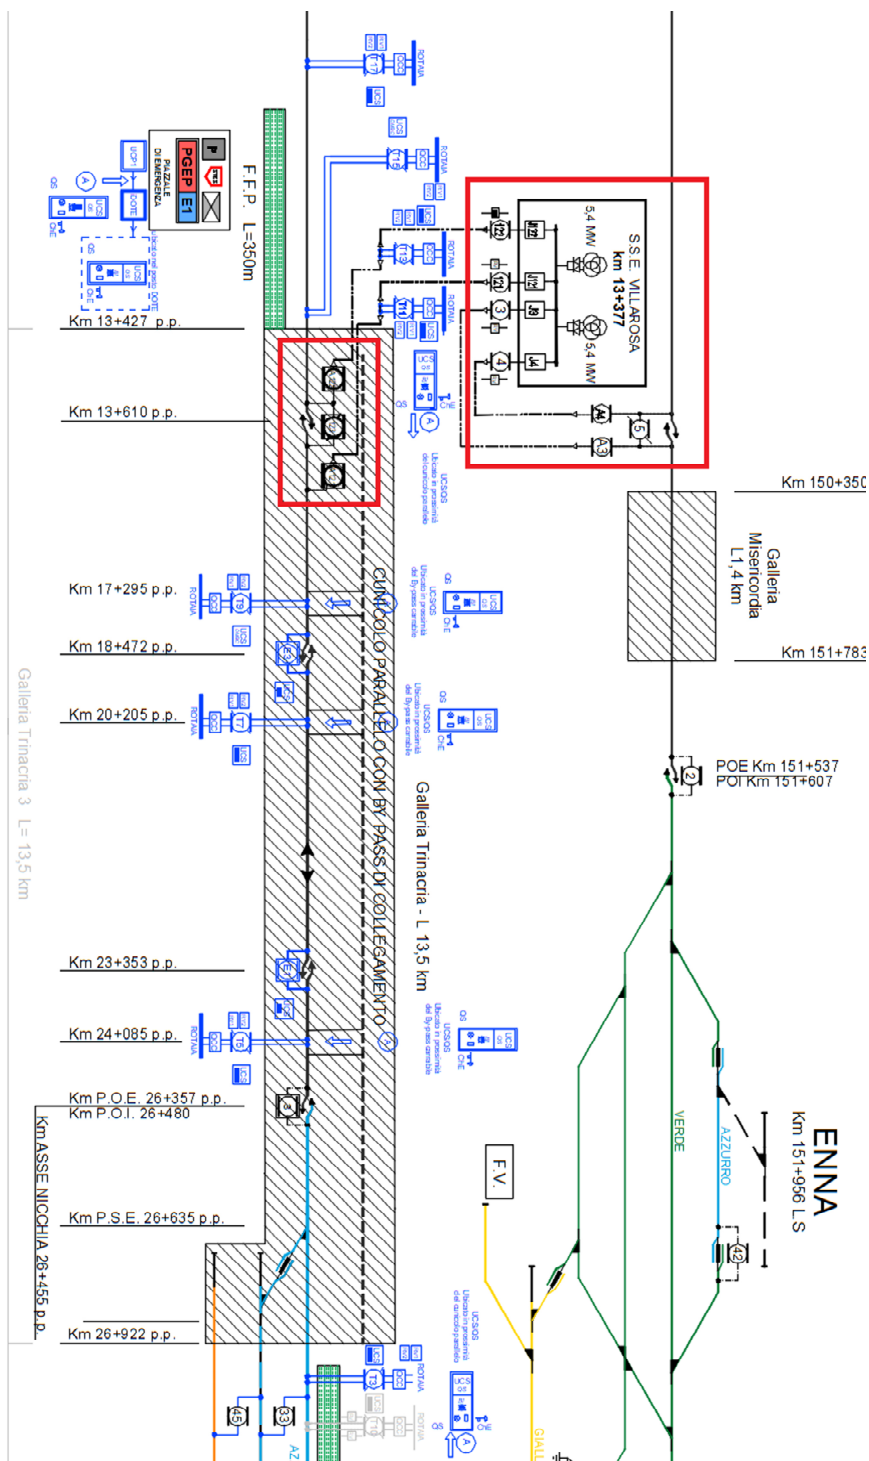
S.S.E. di Villarosa stralcio schema di alimentazione e zone TE
